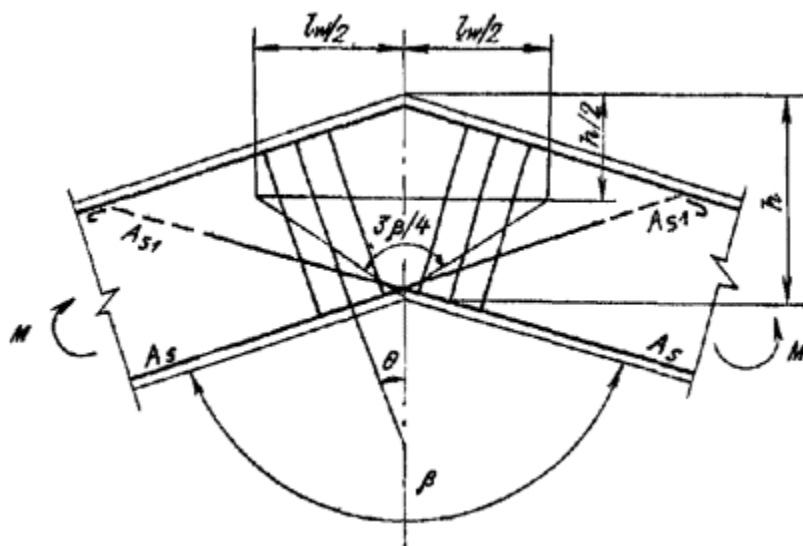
Схема армирования входящего угла сопряжения железобетонных элементов в растянутой зоне
